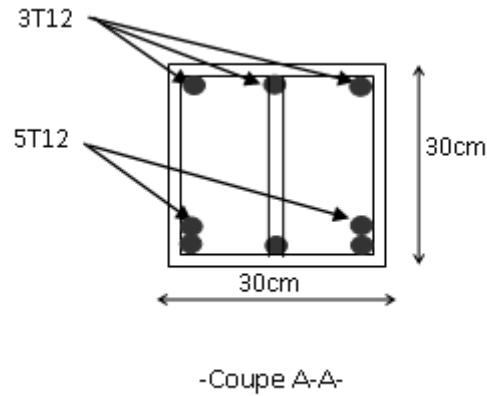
Ferrailage de la poutre brisée:(30x30) cm²
